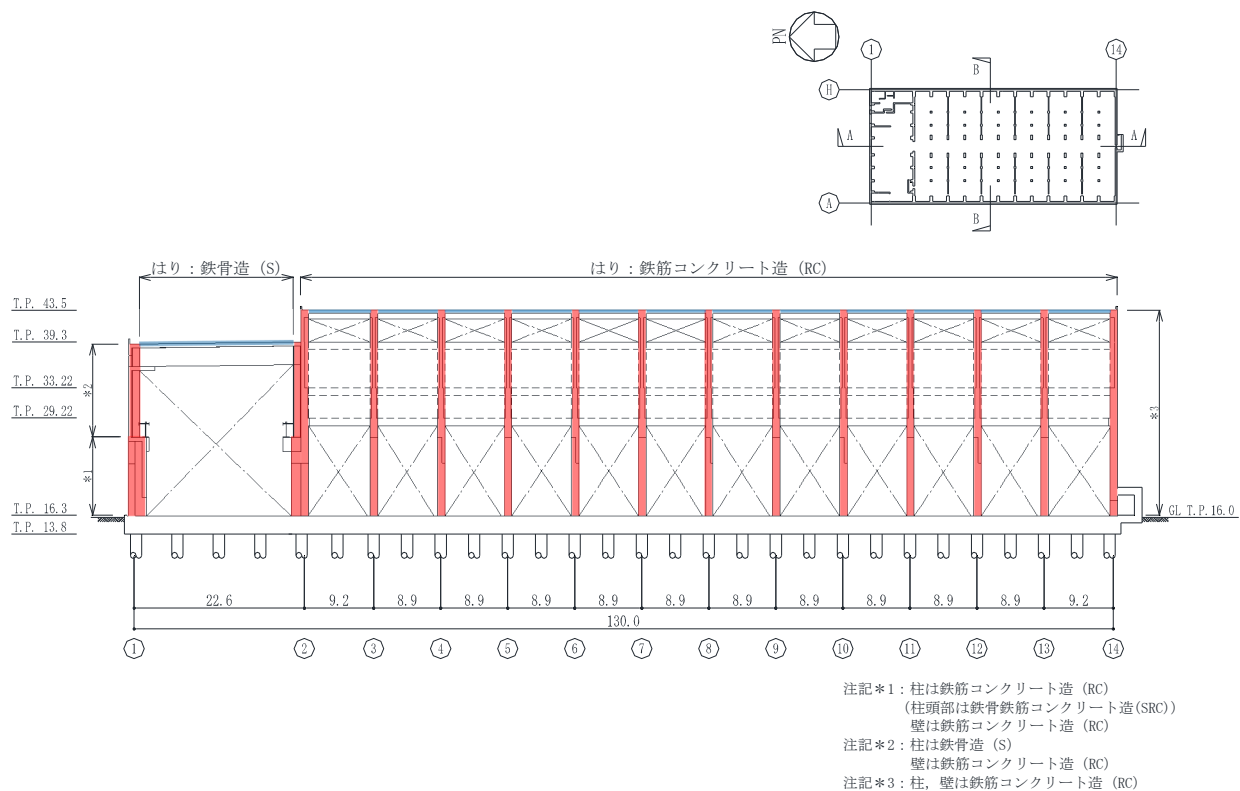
A-A 断面図 (NS 方向) (単位 : m)
